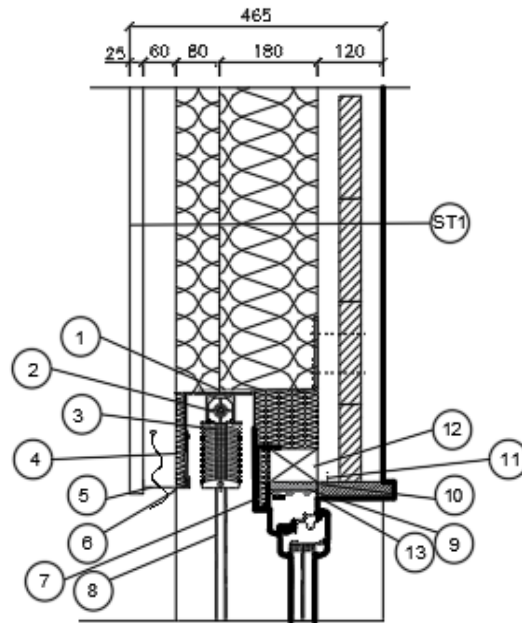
M1:10 DETAIL NADPRAŽIA
